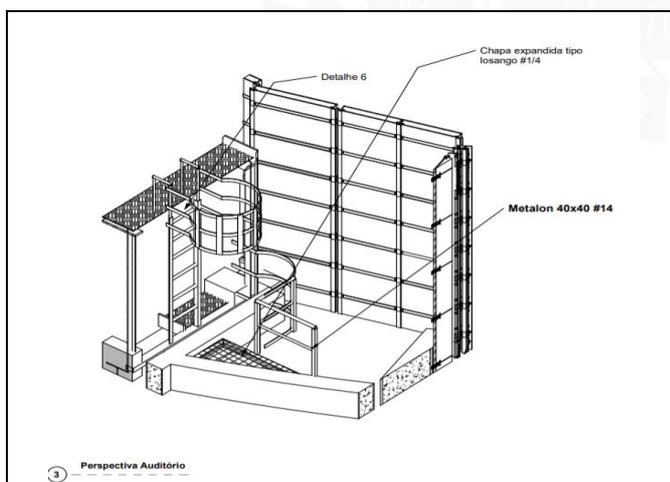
Prancha AQP 004 – Detalhe Auditório Escada Metálica
